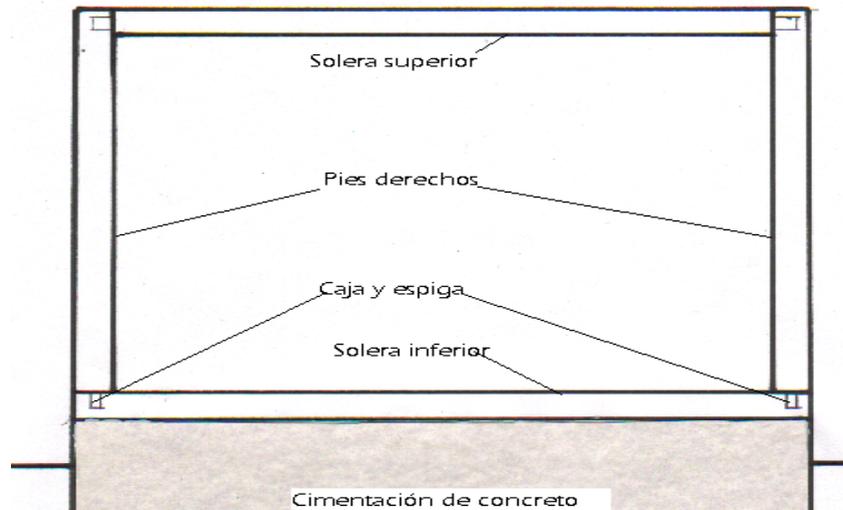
Pórtico de madera maciza sobre cimentación de concreto.
